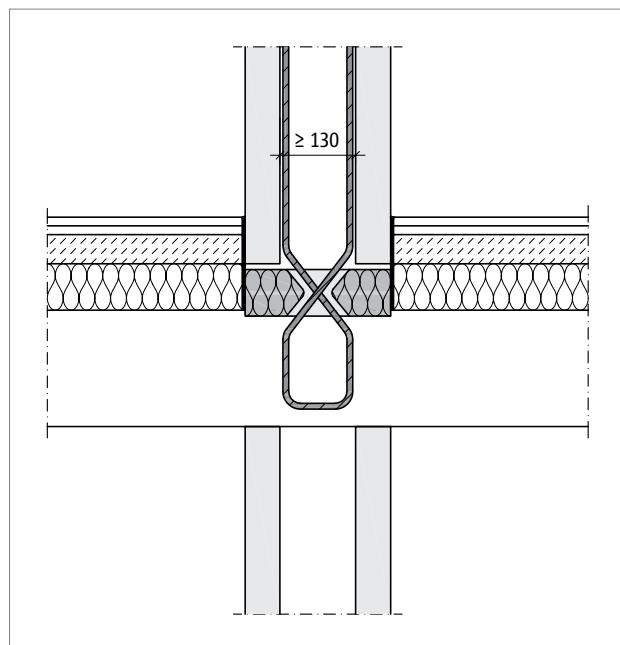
Schöck Sconnex® Typ W: Schematische Darstellung Schöck Sconnex® Typ W bei Doppelwänden und Aufdeckendämmung
